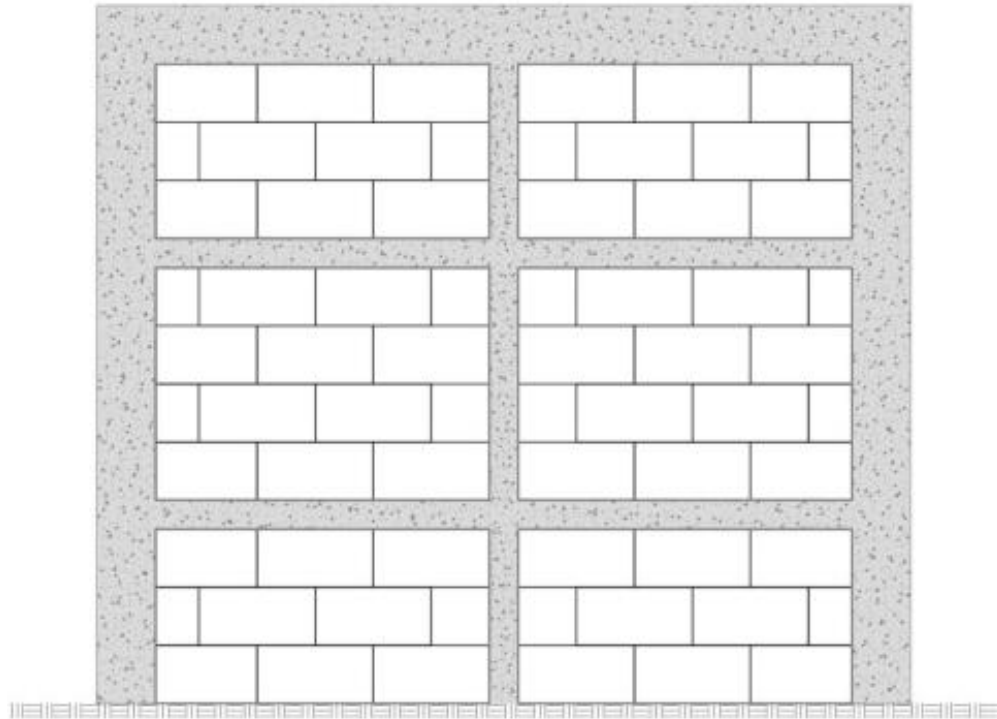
Armado típico para elementos horizontales en MC, con una solera intermedia
